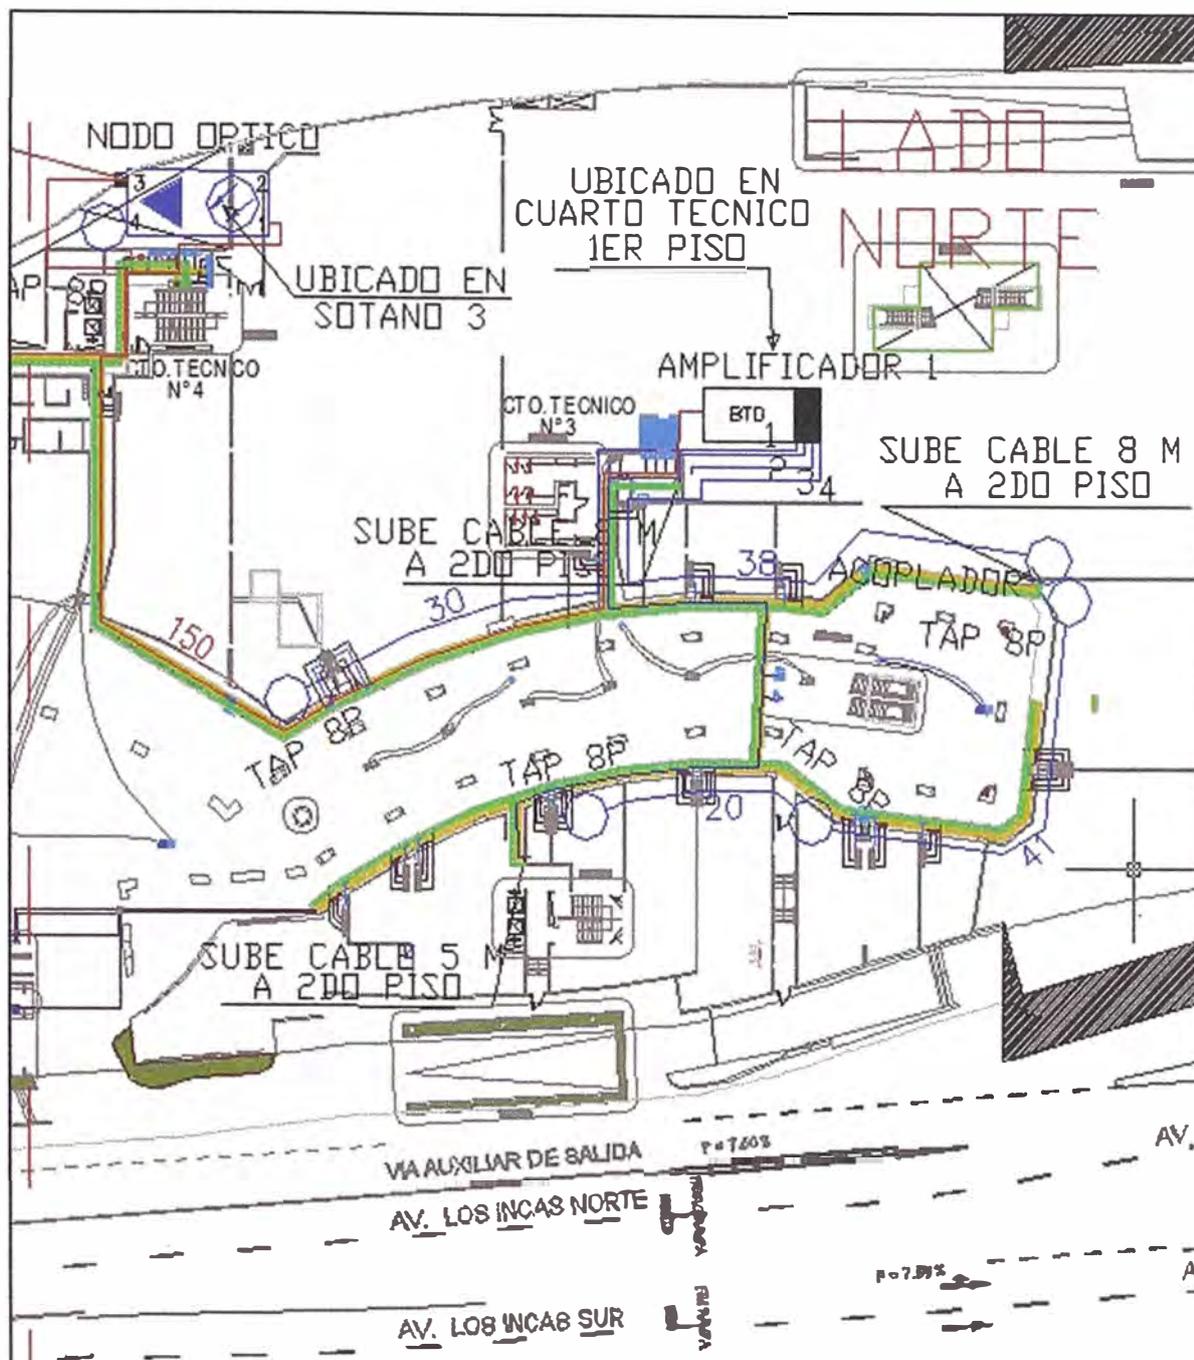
Planta baja del sector norte del C.C. Comercial Parque Lambramani. Fuente: Elaboración propia.
